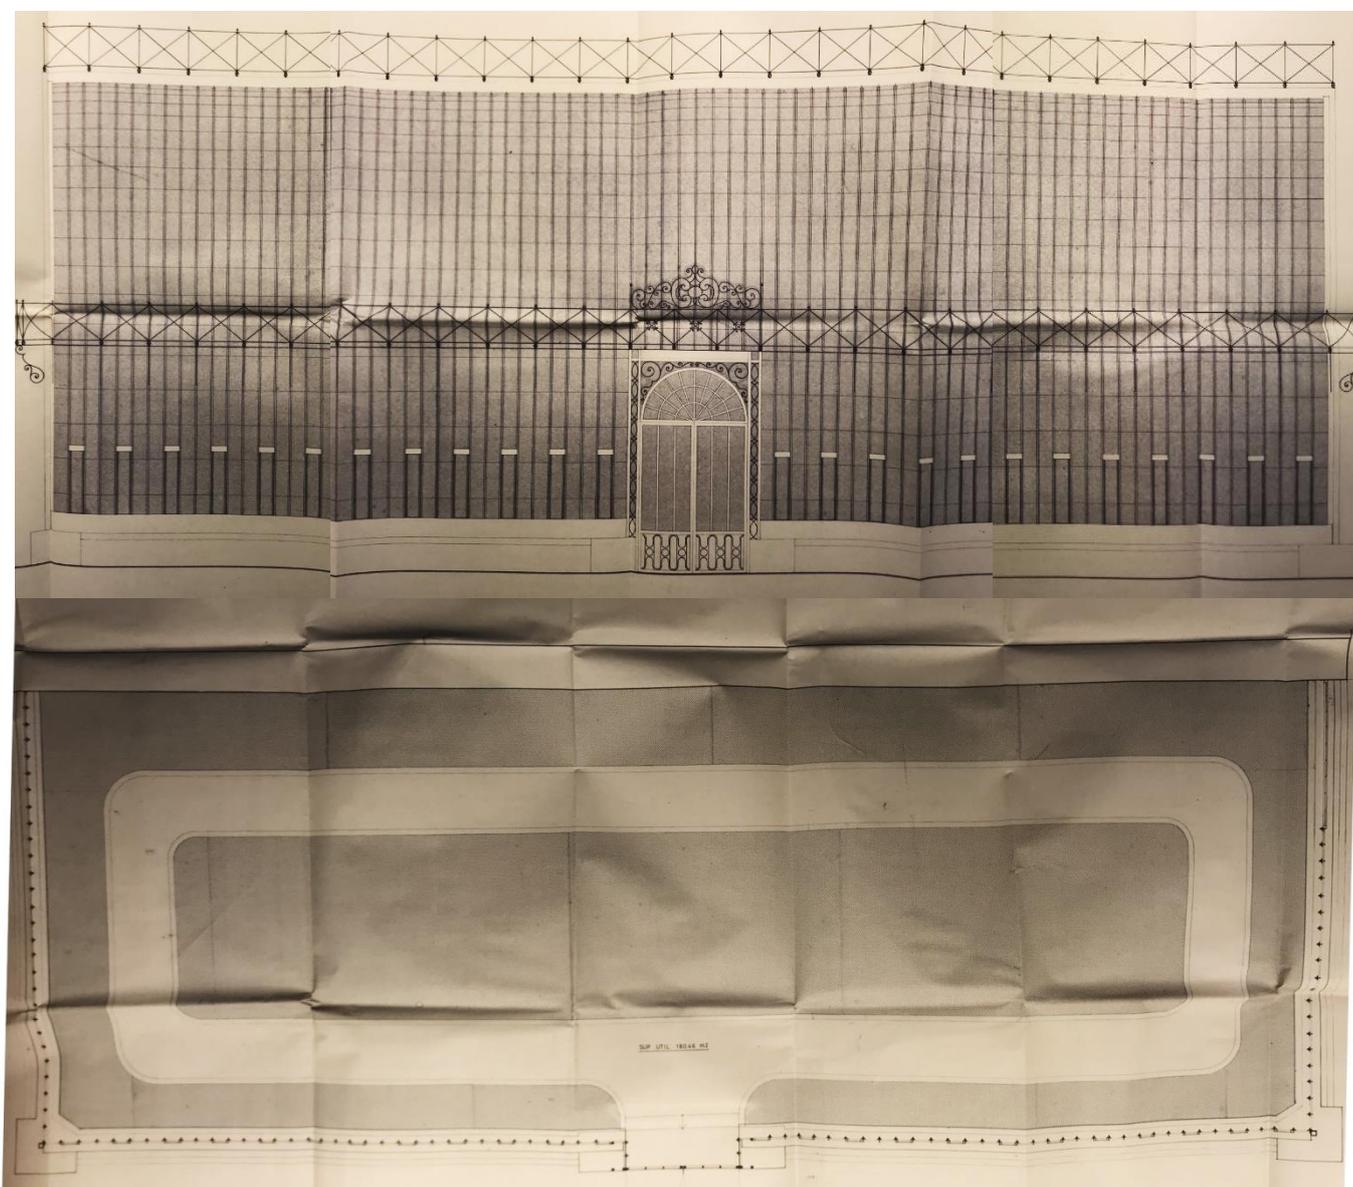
Proyecto de restauración de la Estufa Tropical, alzado y planta.* (1988) Carlos Bento.
